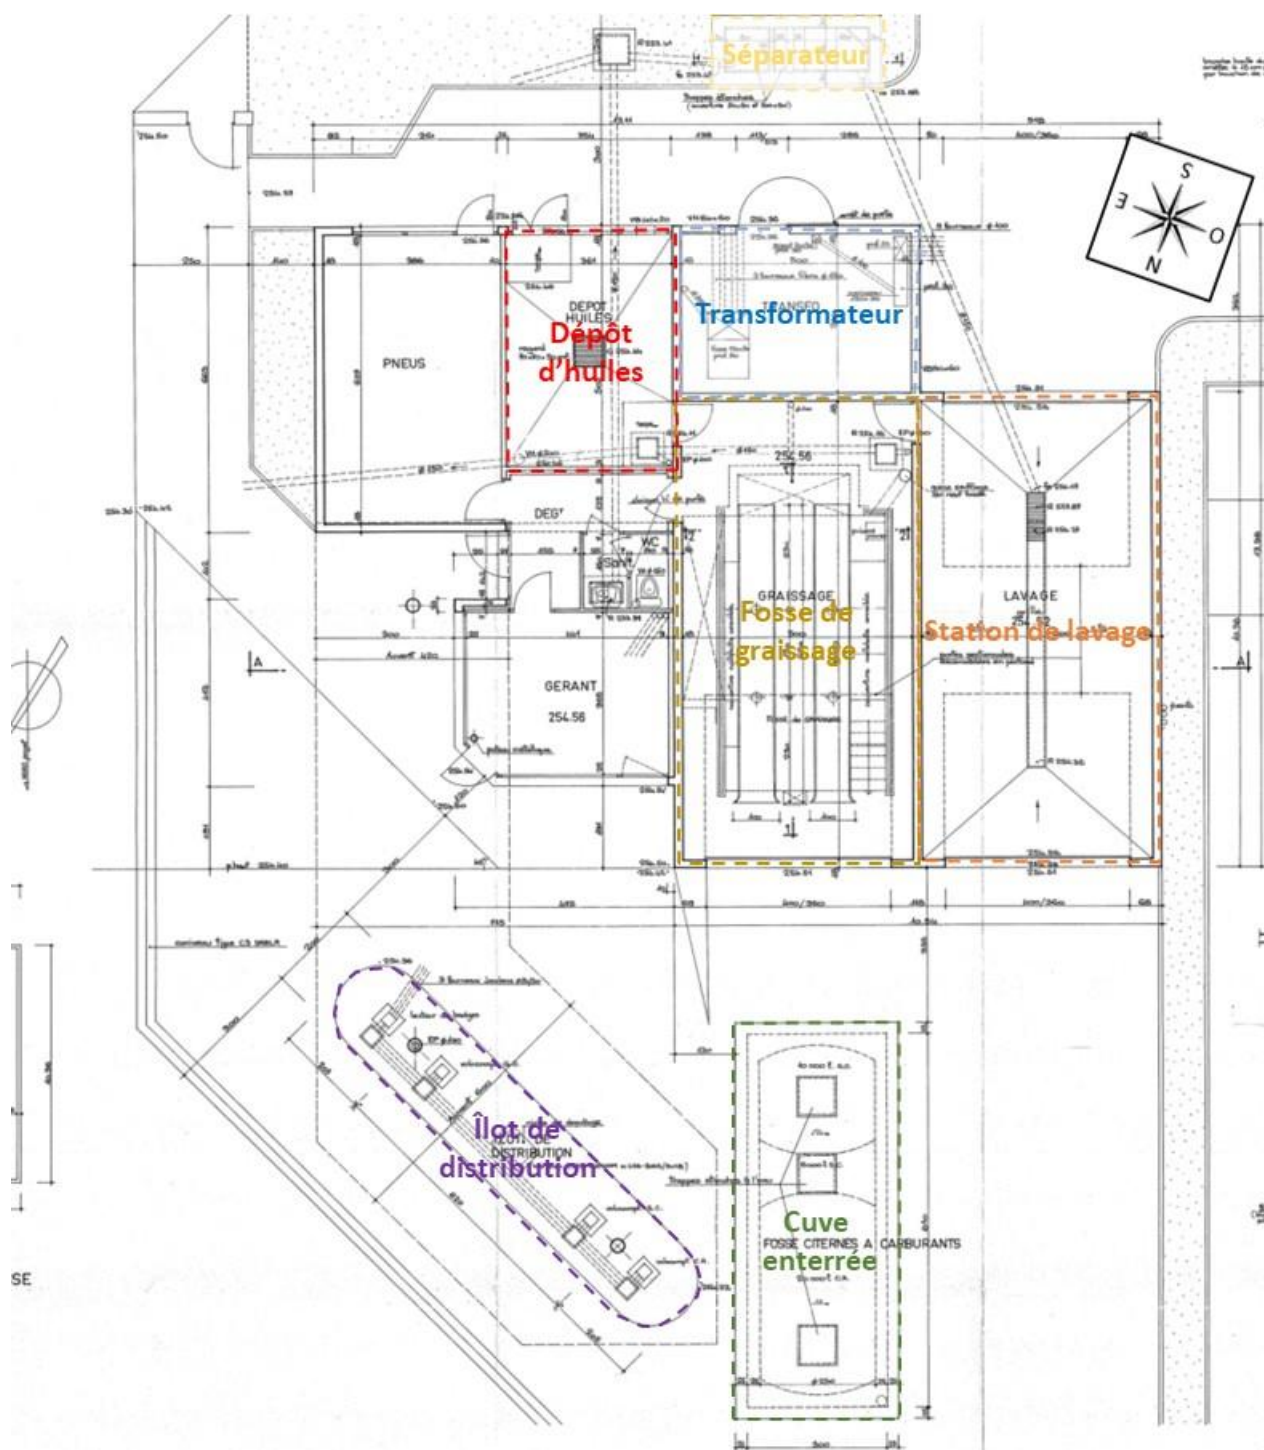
PLAN DE MASSE DU BATIMENT B – PLAN EN DATE DU 25/02/1983
